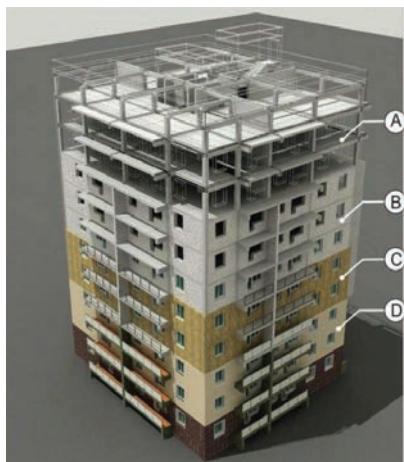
Конструкция здания с монолитным железобетонным каркасом:
